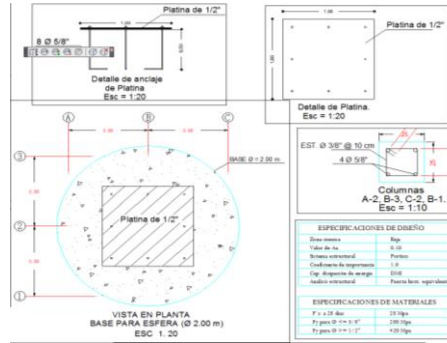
Detalles Columnas, placa maciza, platina y anclaje. Fuente ING Jaime Maestre Rodriguez
